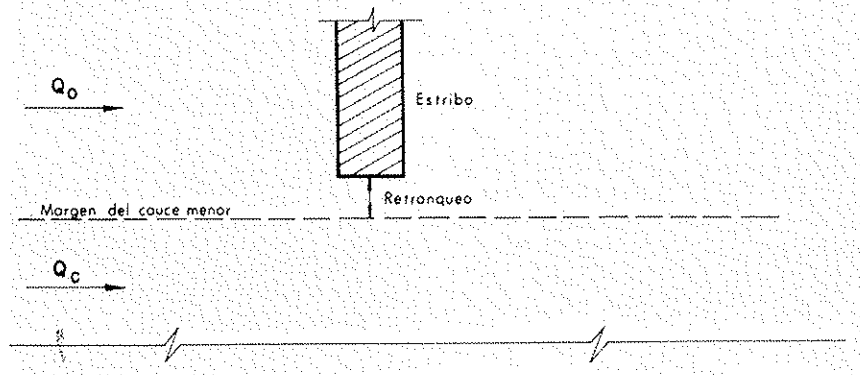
ESTRIBO RETRANQUEADO SITUADO EN CAUCE DE AVENIDAS
